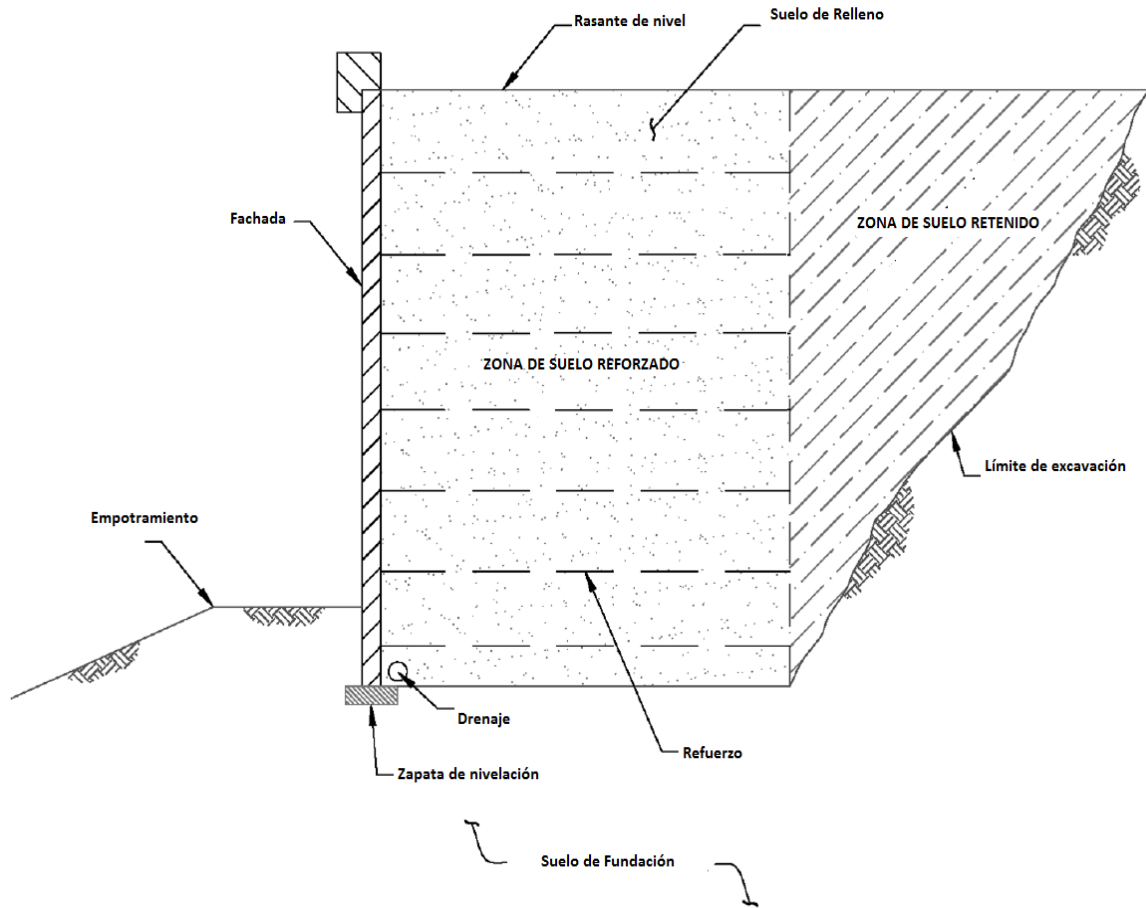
Esquema 2D muro mecánicamente estabilizado. Adaptada Schmidt et al. (2011).
